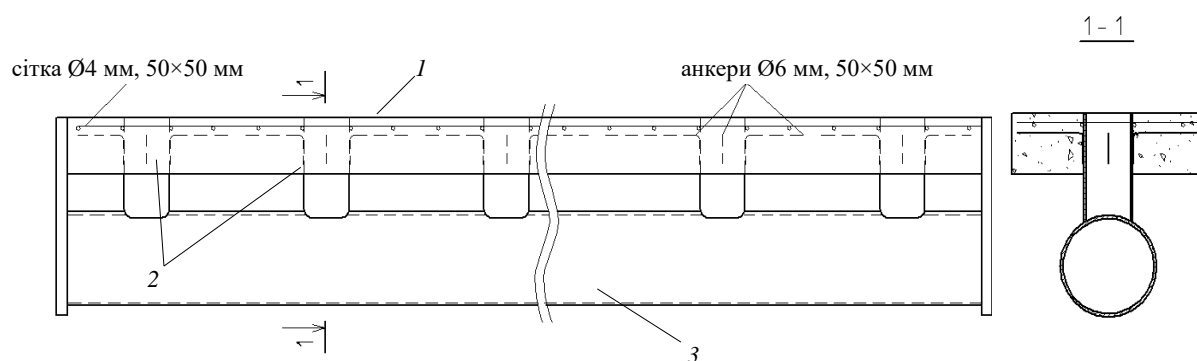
Сталезалізобетонна балка з армуванням трубами:
